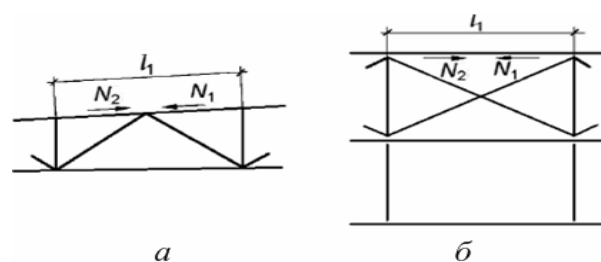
Схеми для визначення розрахункових довжин елементів ферм: а – схема ферми; б – схема поперечних горизонтальних в'язей між фермами (вид зверху)
